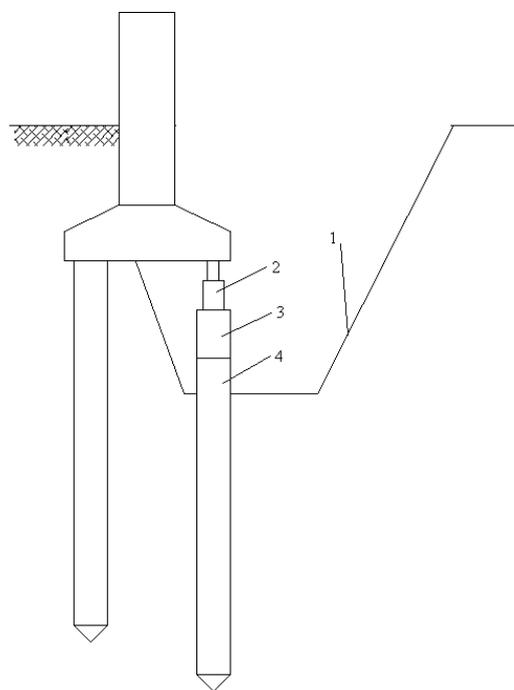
Вдавливание существующих свай: 1 – временный котлован; 2 – гидравлический домкрат; 3 – металлическая труба; 4 – существующая свая
